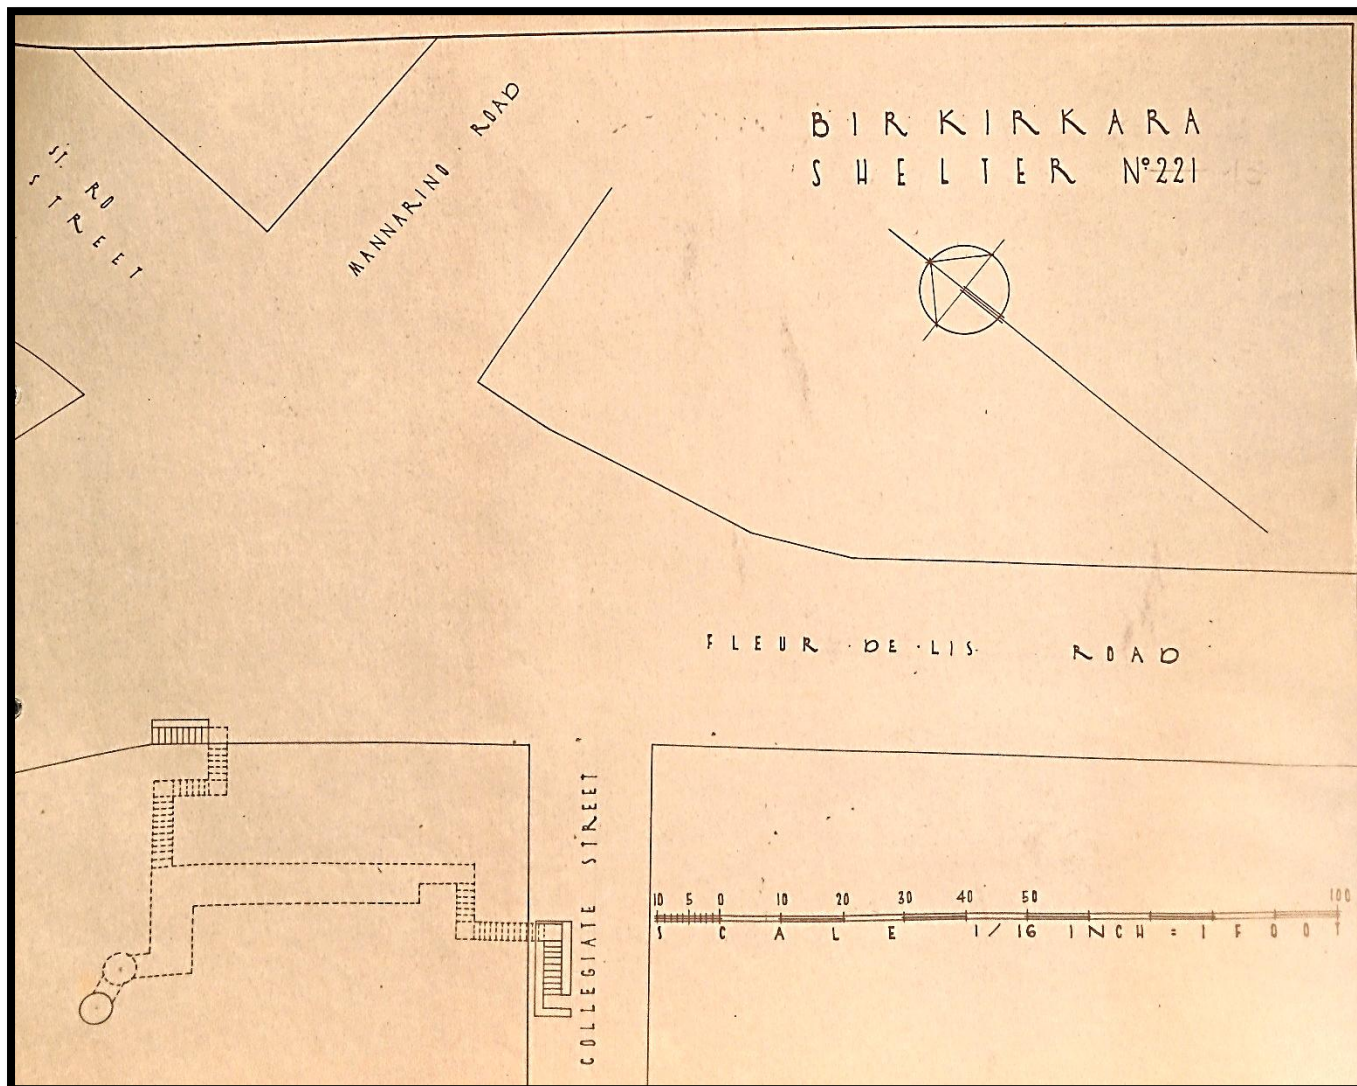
Planta do Abrigo nº 221 (13) "St. Rd Street – Mannarino Road – Fleur-de-Lis-Road-Collegiate Street."
